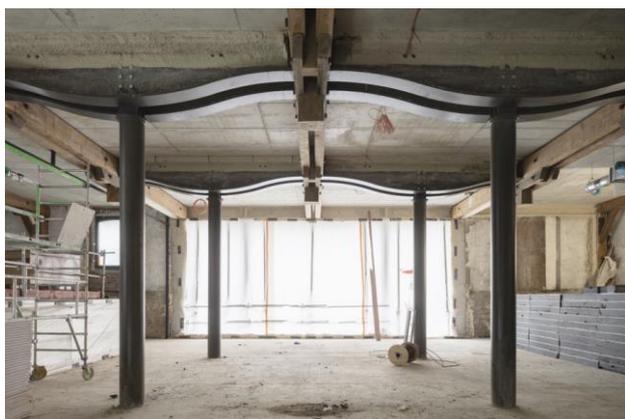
Le lobby et sa nouvelle charpente métallique avec les poutres bois existantes. © Schnepf Renou
